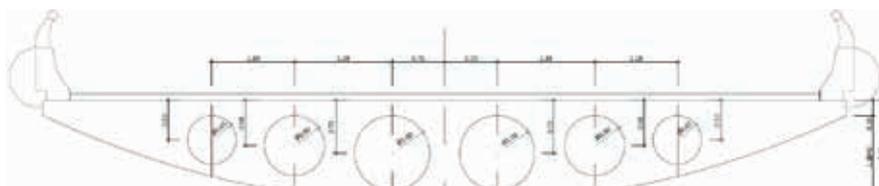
Sección tipo del tablero de la estructura del Nudo de Colmenar
